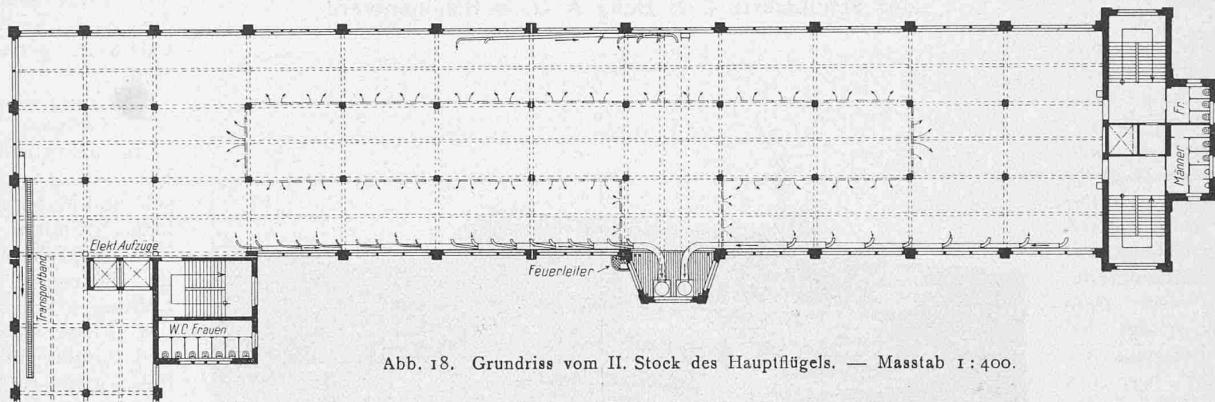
Grundriss vom II. Stock des Haupthauses. — Maßstab 1:400.
